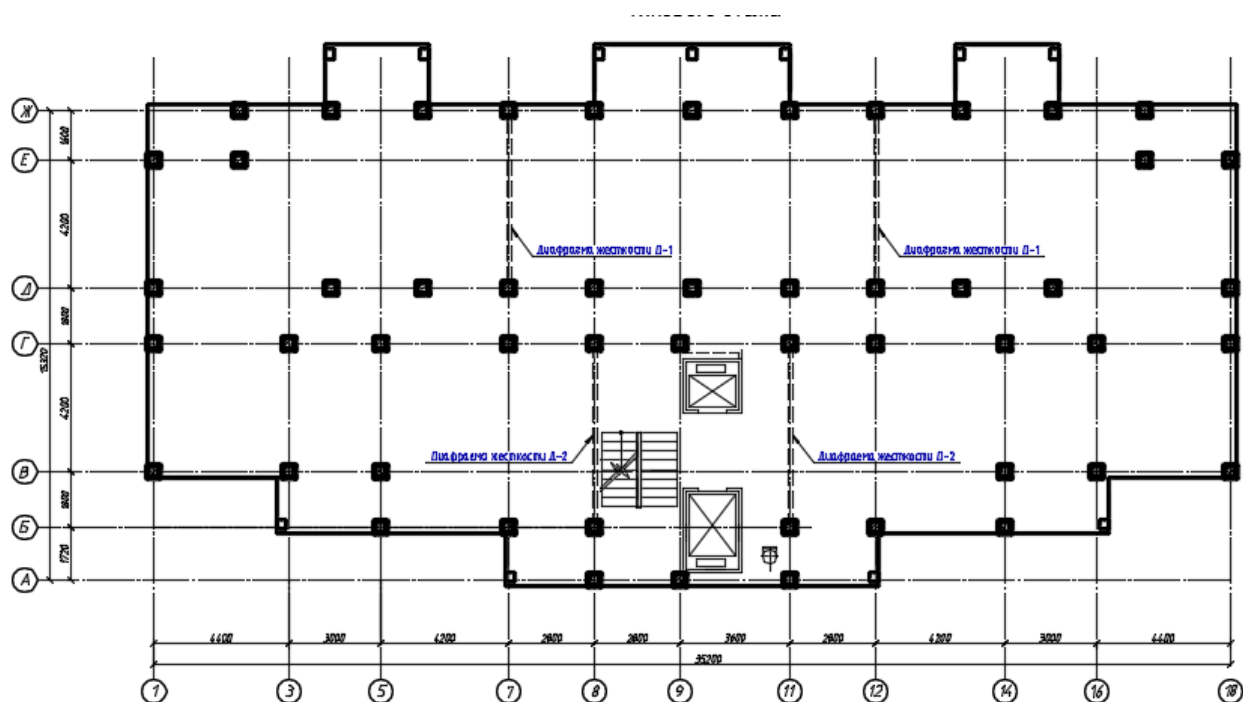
Безбалочное безкапитальное монолитное перекрытие
